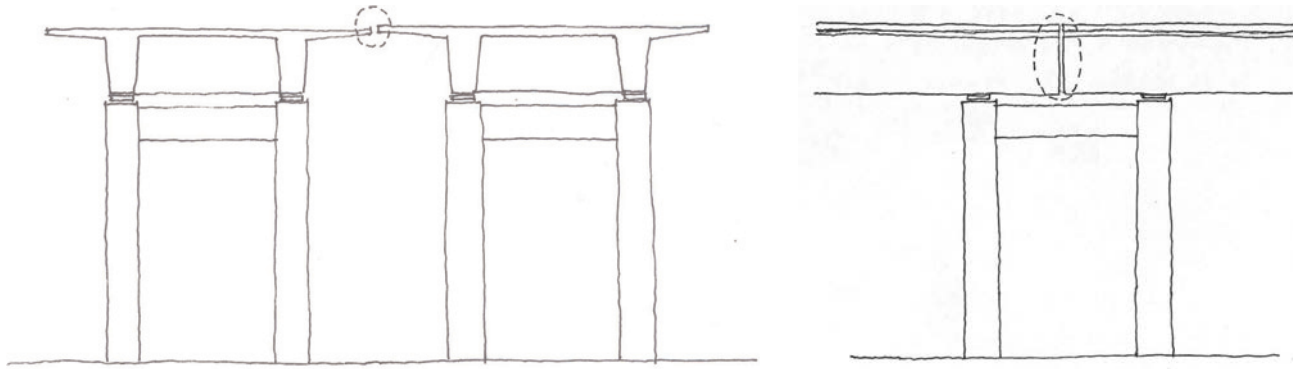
Juntas longitudinales entre vanos o tablero y estribo o transversales entre tableros.
